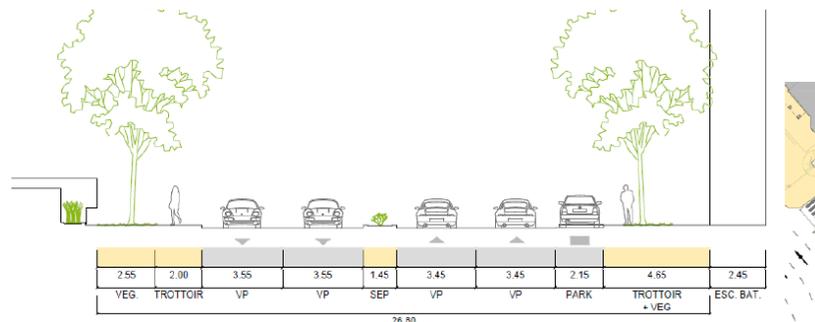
Coupe 1A-1 actuelle - avenue Louison Bobet
